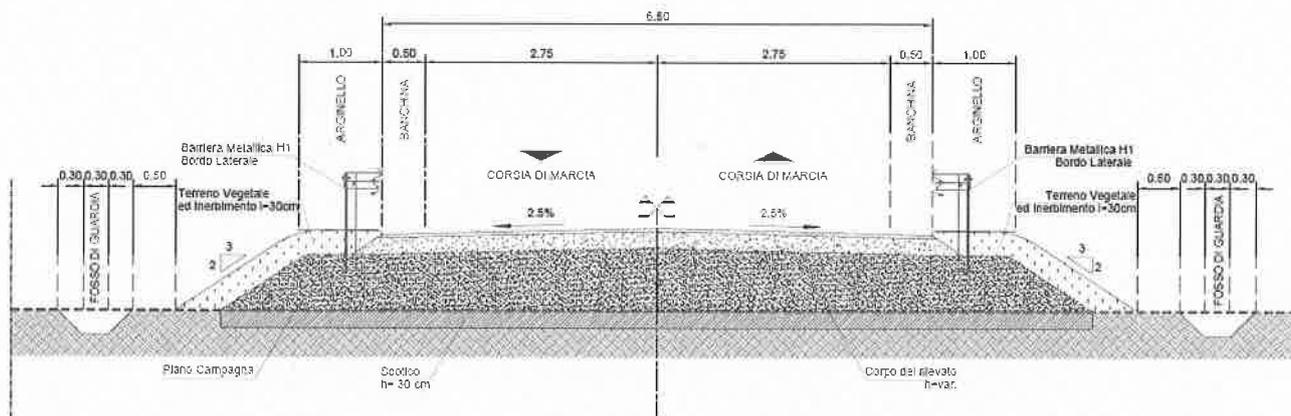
Sezione Tipo in Rilevato h > 1,00 m
